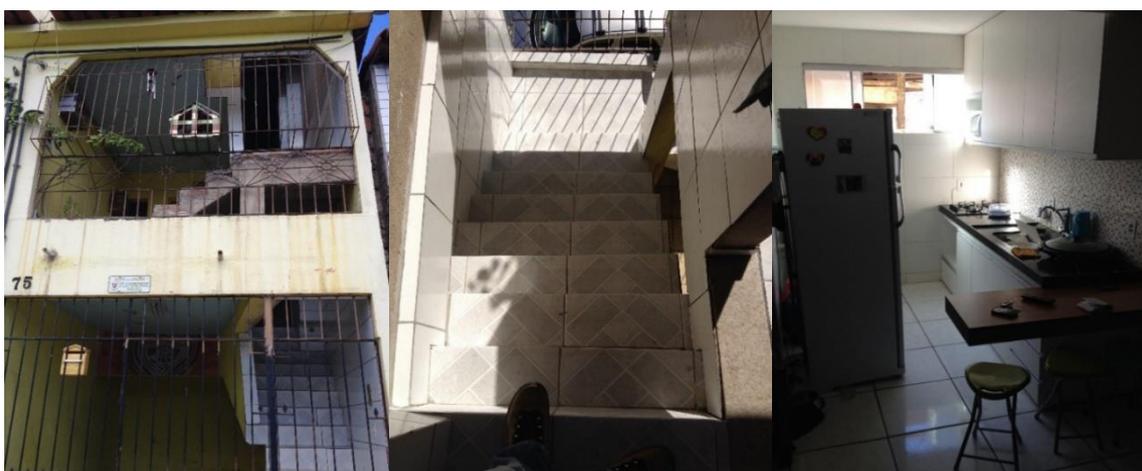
Da esquerda para direita, primeira foto mostra no primeiro pavimento a casa que já existia e no segundo pavimento a habitação que foi construída; a segunda foto mostra a escadaria de acesso ao segundo pavimento que foi feita com o crédito; a terceira foto mostra a cozinha que foi feita com os créditos habitacionais acessados pelo TC6.
